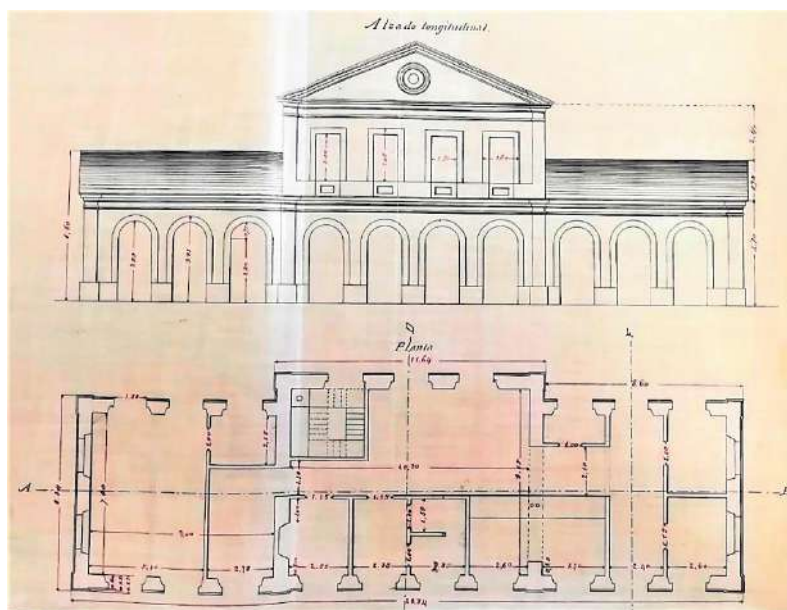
Modelo de estación de 2ª clase aprobado para la línea (alzado y planta). Archivo autor
